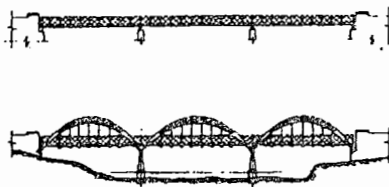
Arco superior como reforço de ponte em viga treliçada contínua
